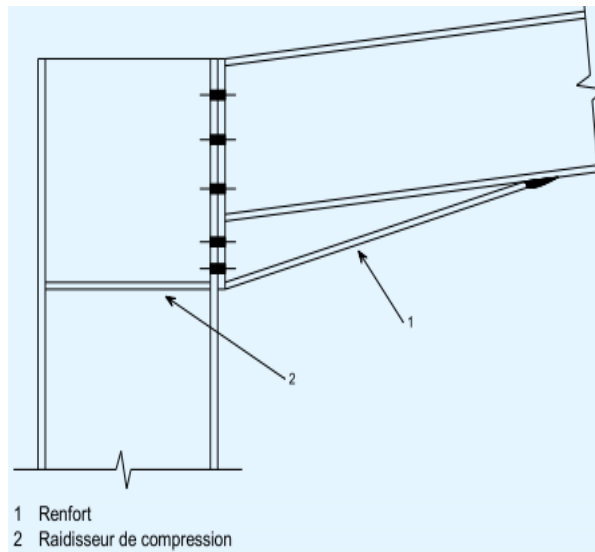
Attache poutre-poteau typique (renfort de jarret).
